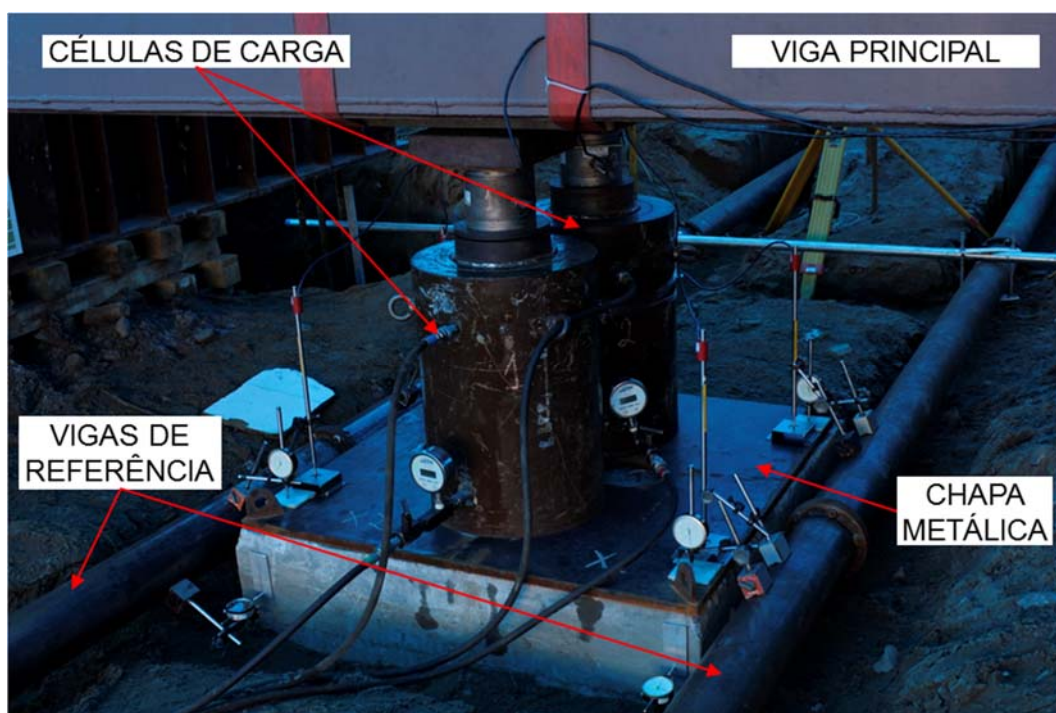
Sistema de aplicação de cargas durante a prova de carga estática de topo
